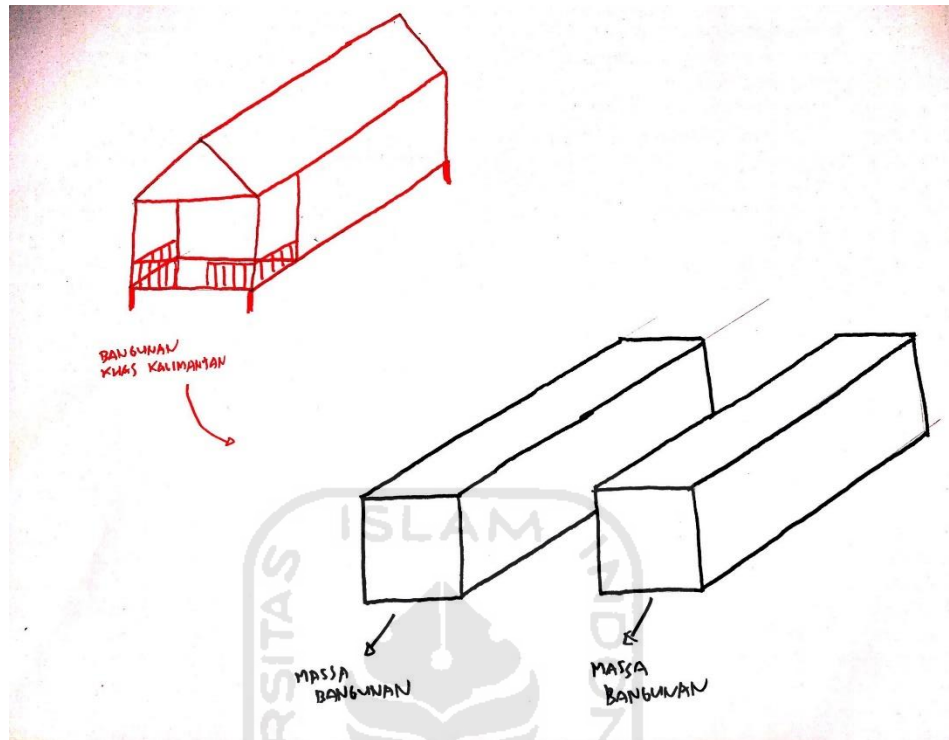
Konsep Awal Ruang Perencanaan Ulang
